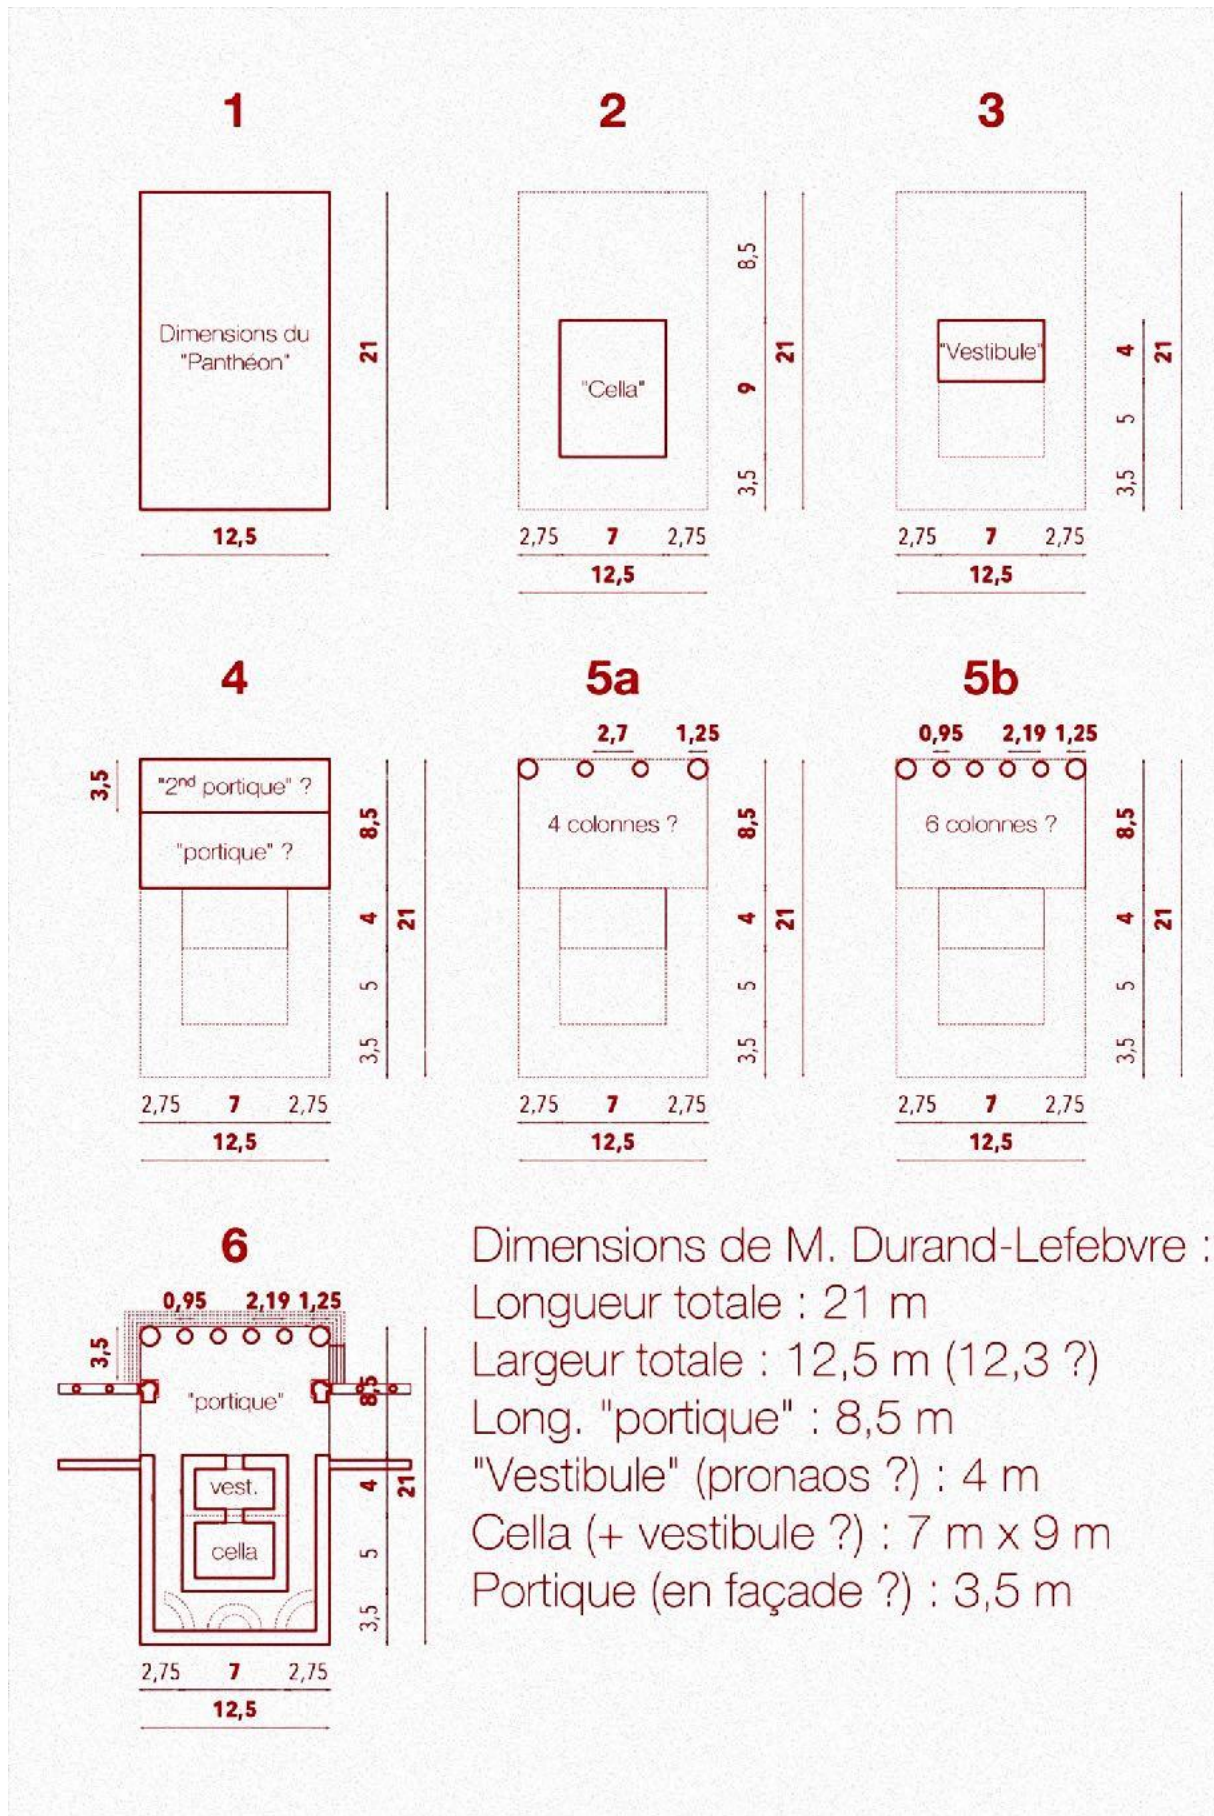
Tracé du plan du temple d'après les dimensions de M. Durand-Lefebvre, 1/500.
